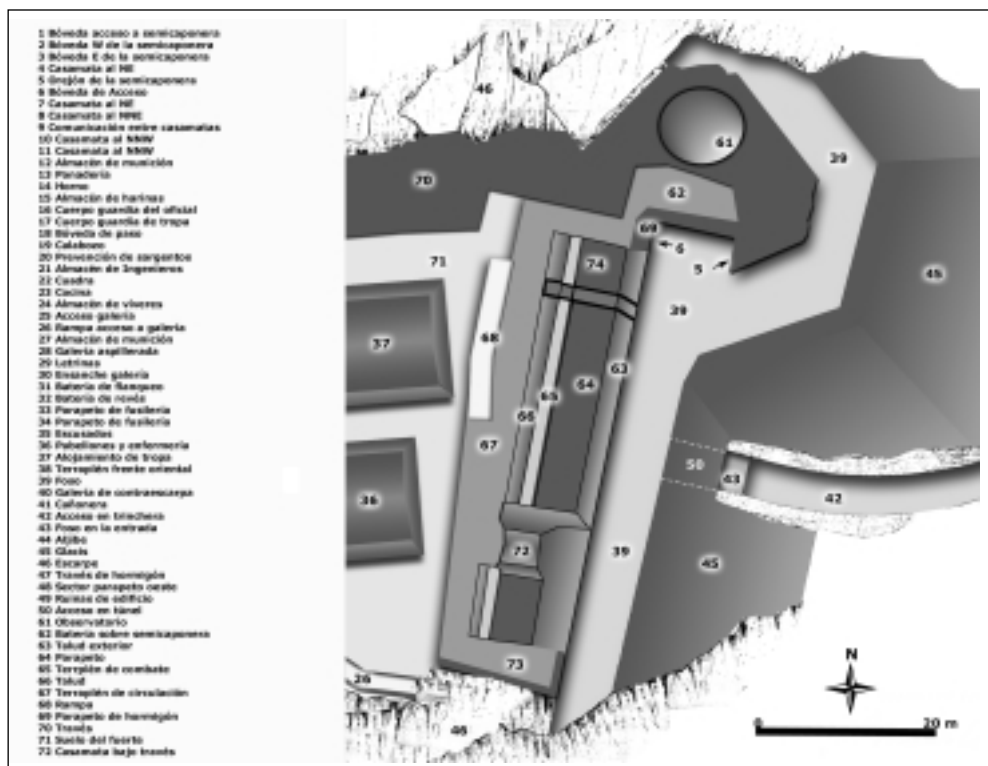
Fuerte de Coll de Ladrones. Planta de terraplenes (sector oriental).
